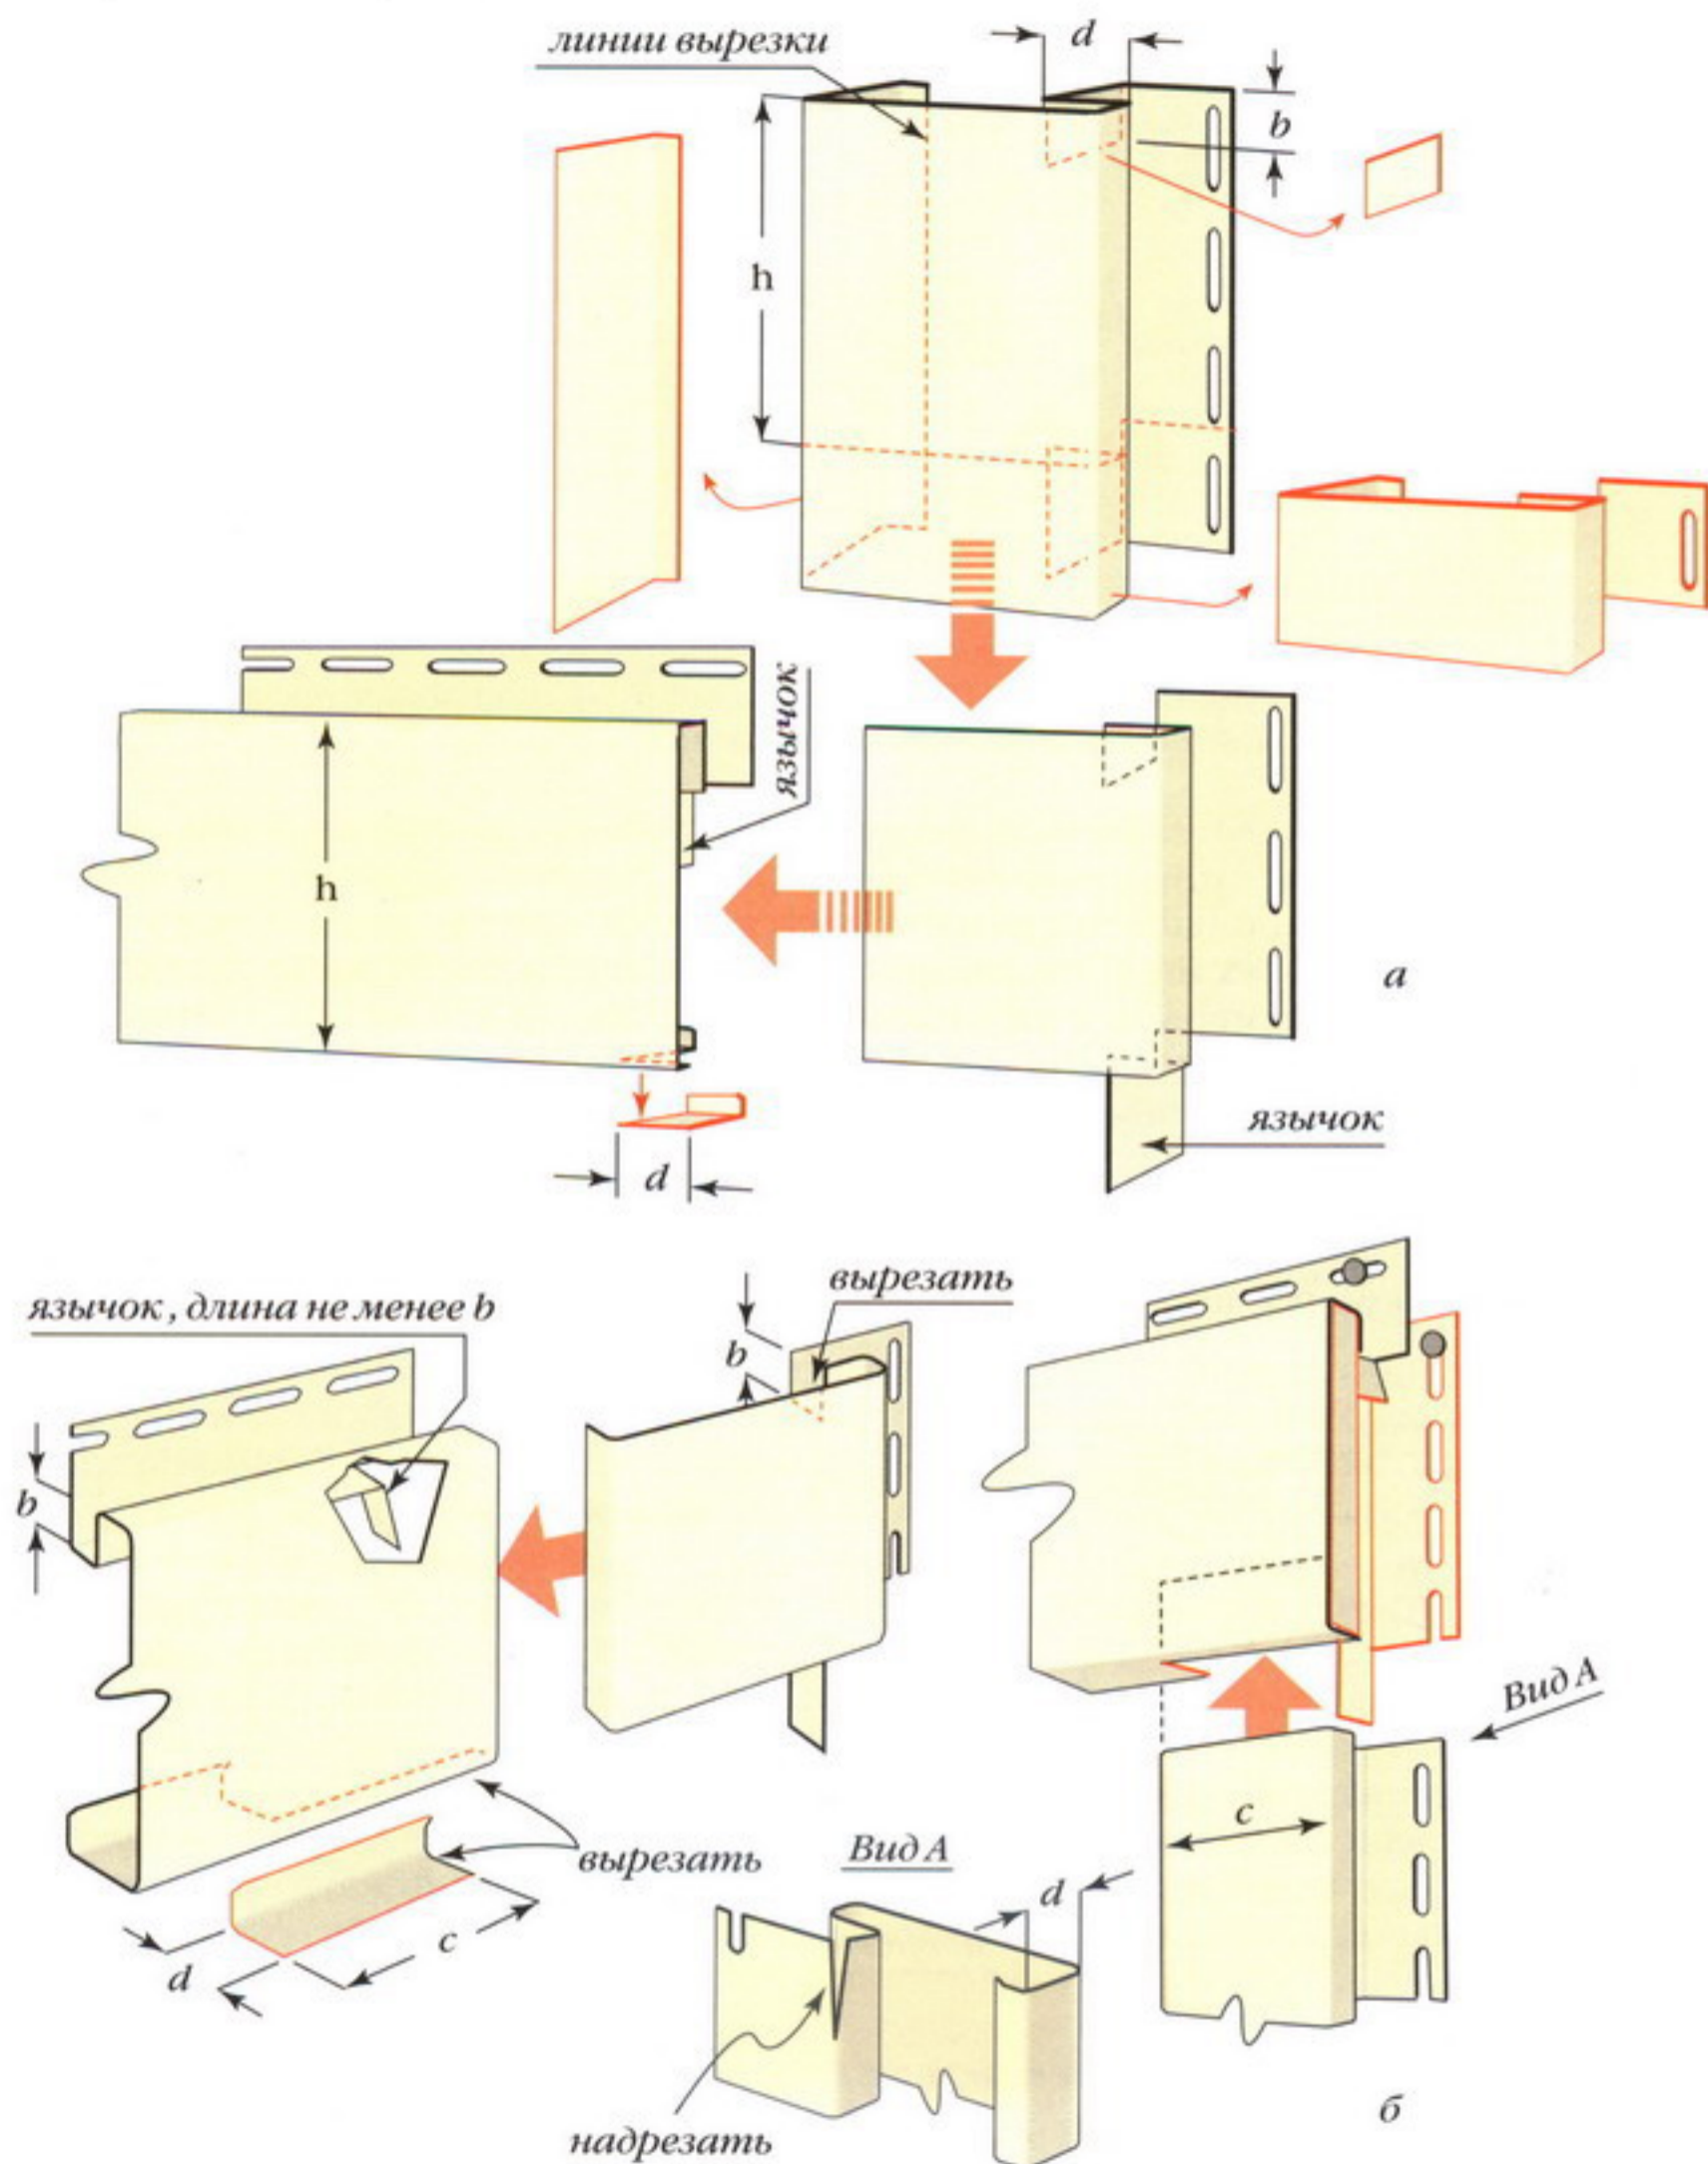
Изготовление угловых заглушек из дополнительного материала: а — изготовление заглушки для прямоугольного угла; б — измененный вариант изготовления заглушки и узел стыкования обвязки оконных и дверных проемов
